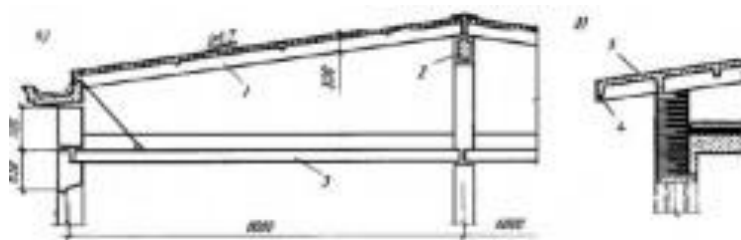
Сборная железобетонная крыша из ребристых панелей: а - с карнизными блоками, б — без карнизных блоков, 1 — ребристая панель, 2 — прогон, 3 — чердачное перекрытие, 4 — ребристая панель с карнизным свесом, 5 - бронированный рубероид
